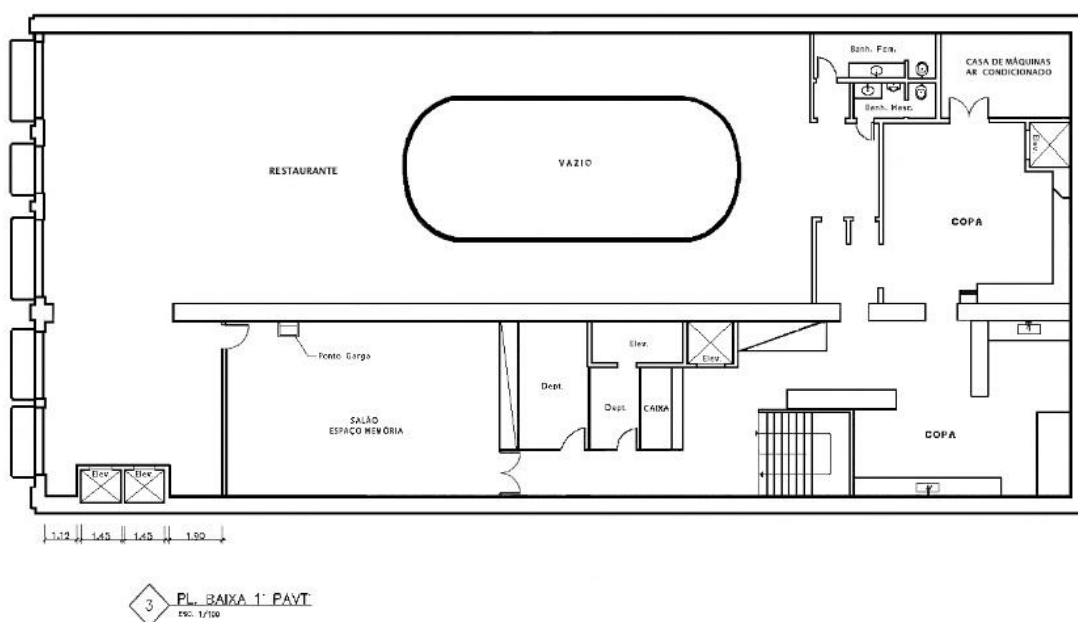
Planta baixa 1º pavimento – Confeitaria Colombo.
